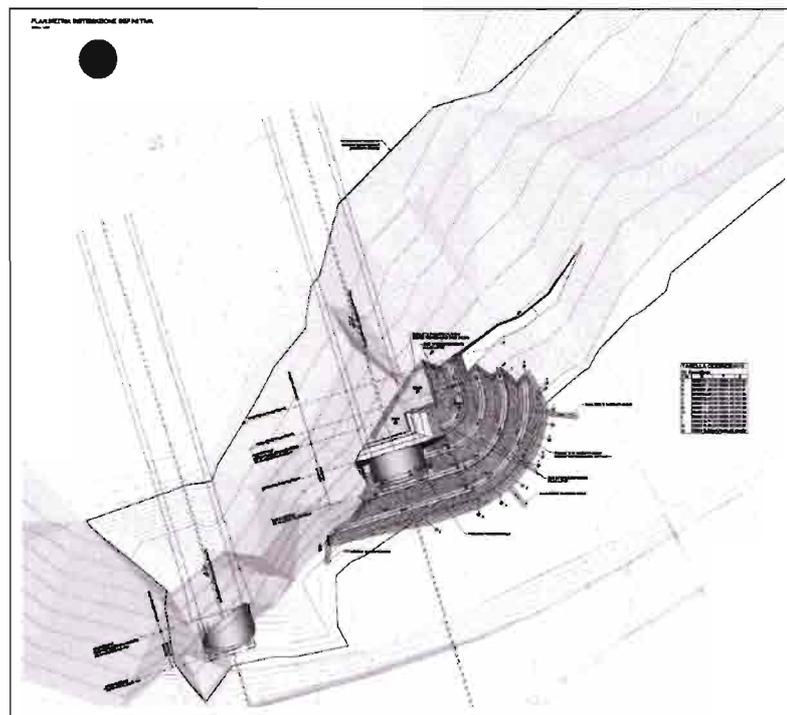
Stralcio planimetrico imbocco Scaleres Sud – Fase definitiva
